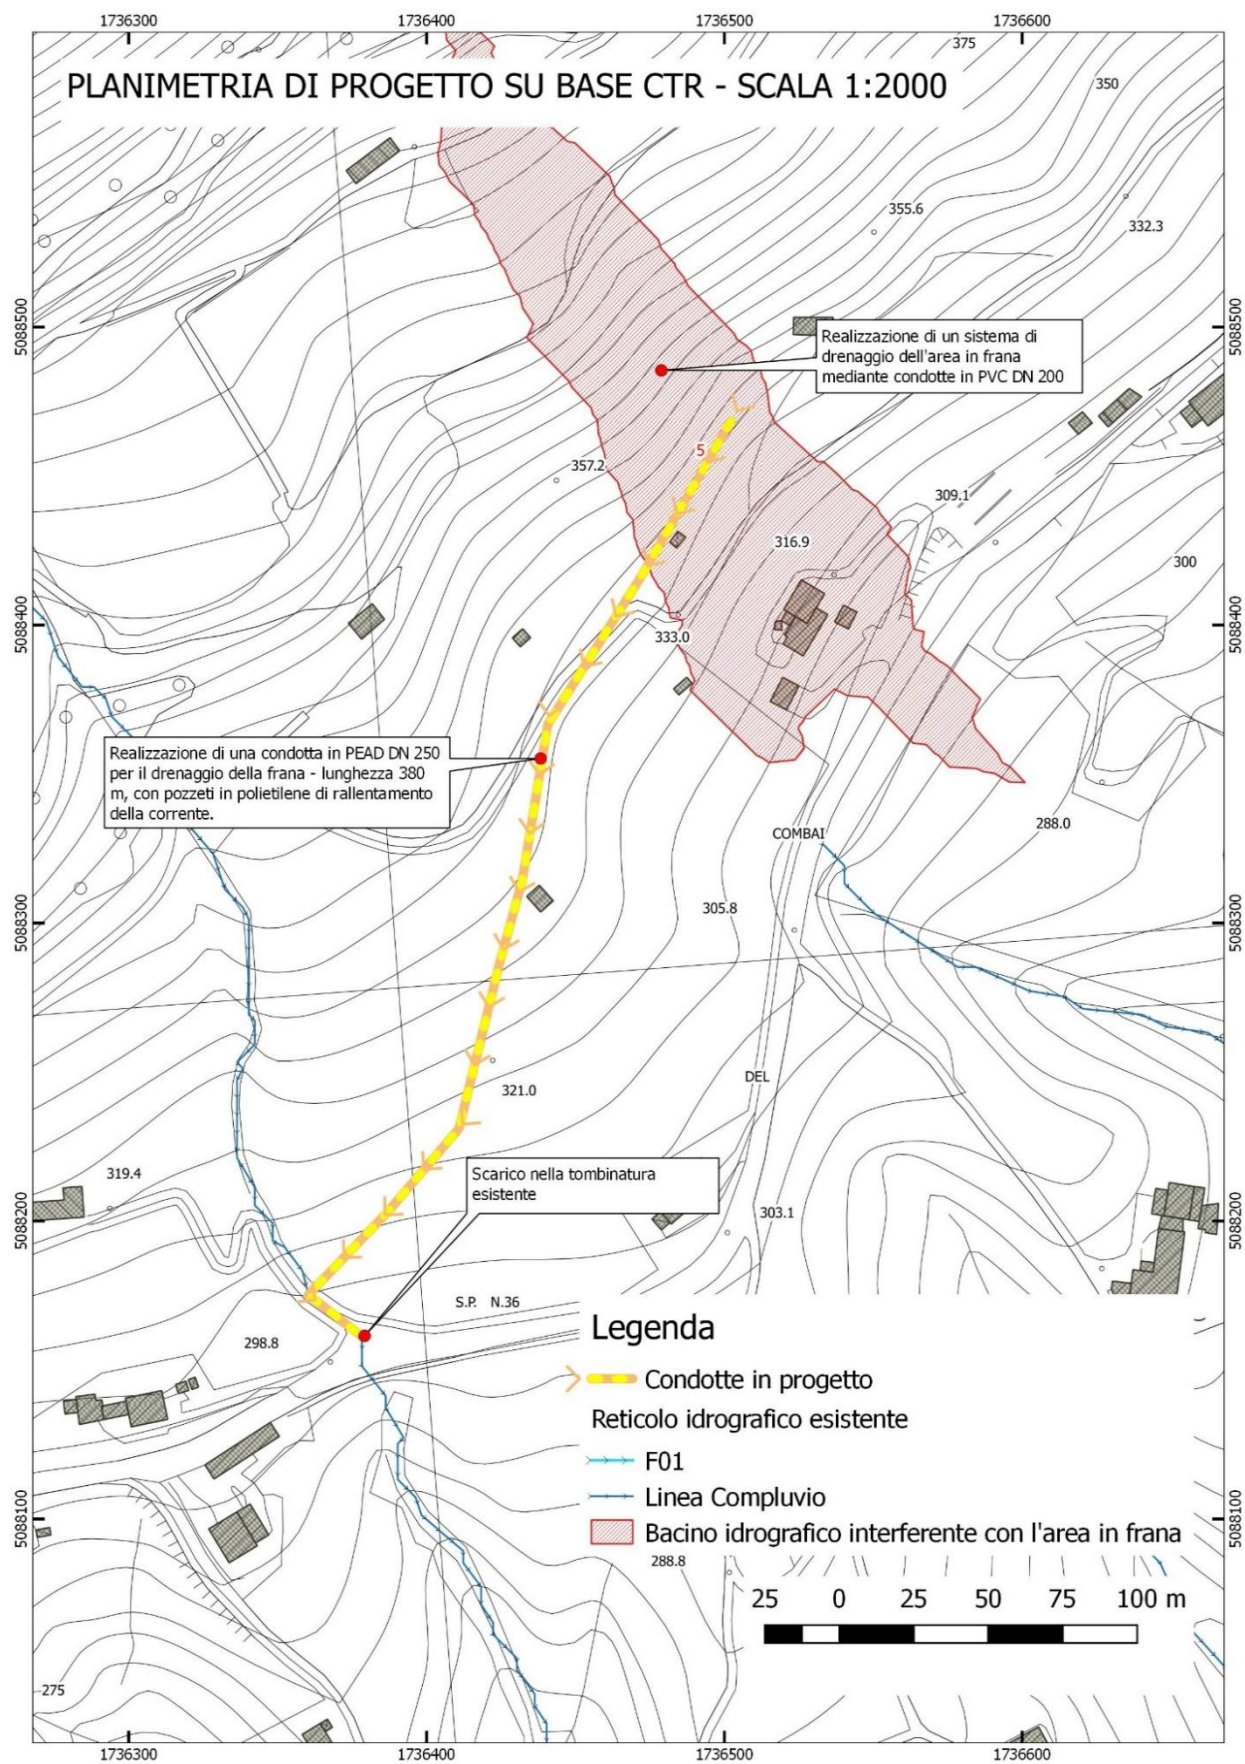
Intervento n.4 – Sistemazione della frana a Santo Stefano - Planimetria di progetto
